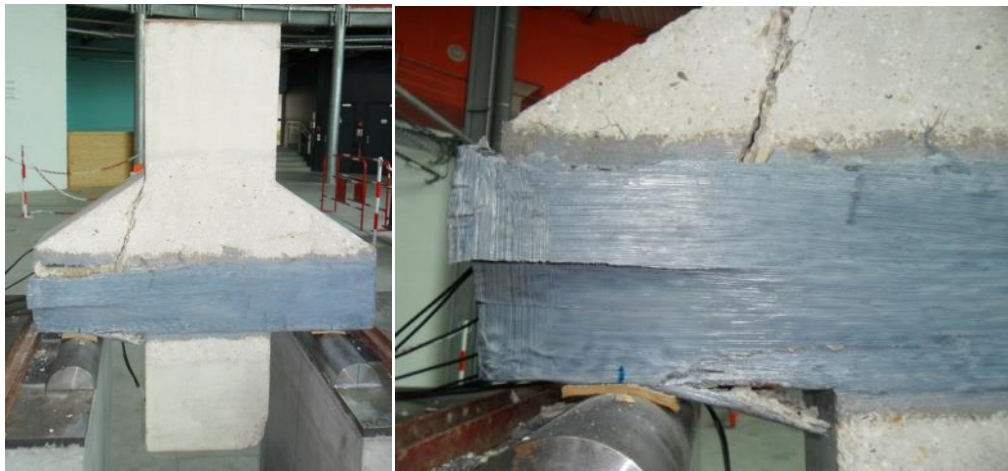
Rupture de la console renforcée par plaque de deux côtés, 3 couches unidirectionnelles + plaque collée sur les deux appuis – CP3u + PA3u
